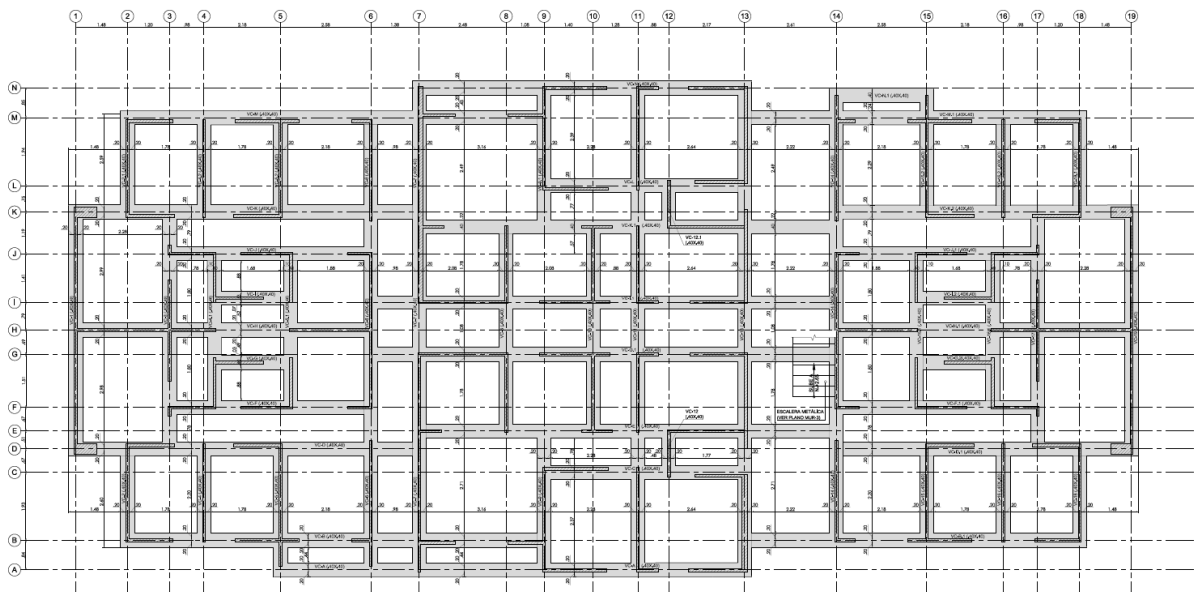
Planta típica de cimentación con viga corrida. Fuente: Imágenes de planos DUAL INGENIERÍA ESTRUCTURAL SAS. Archivo personal, recuperado en el 2017.
